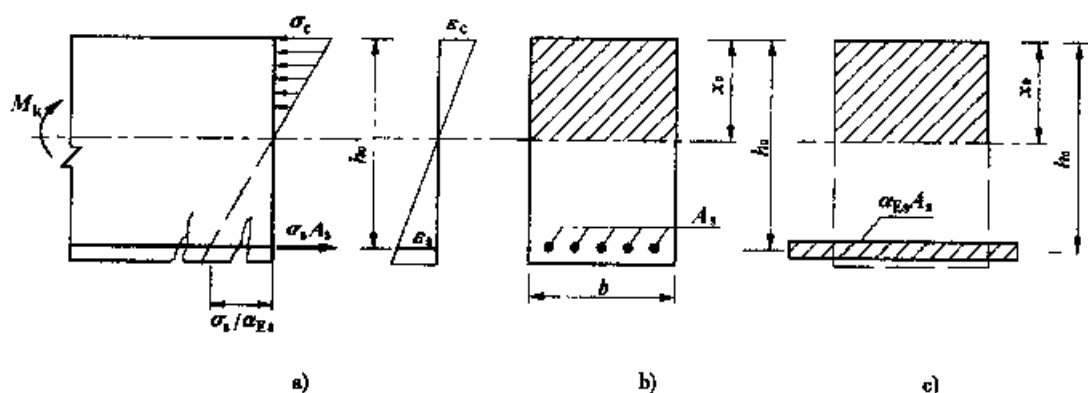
按弹性理论计算钢筋混凝土受弯构件正截面应力计算图式
